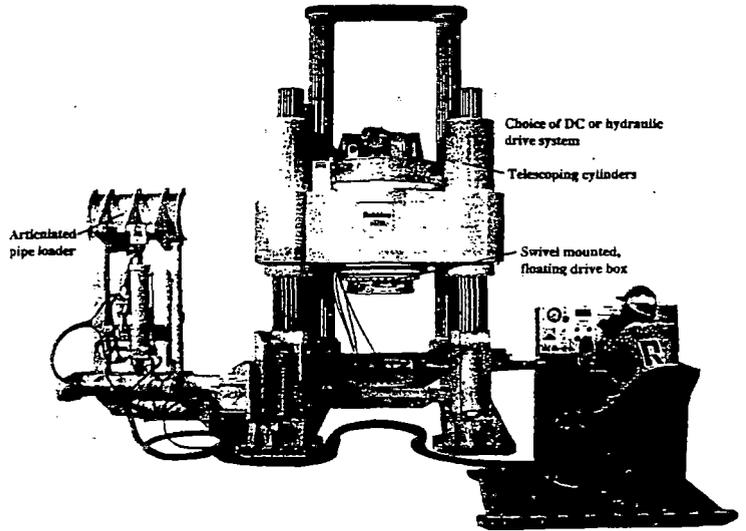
Maquina de perforación de túnel (Raise Boring)
